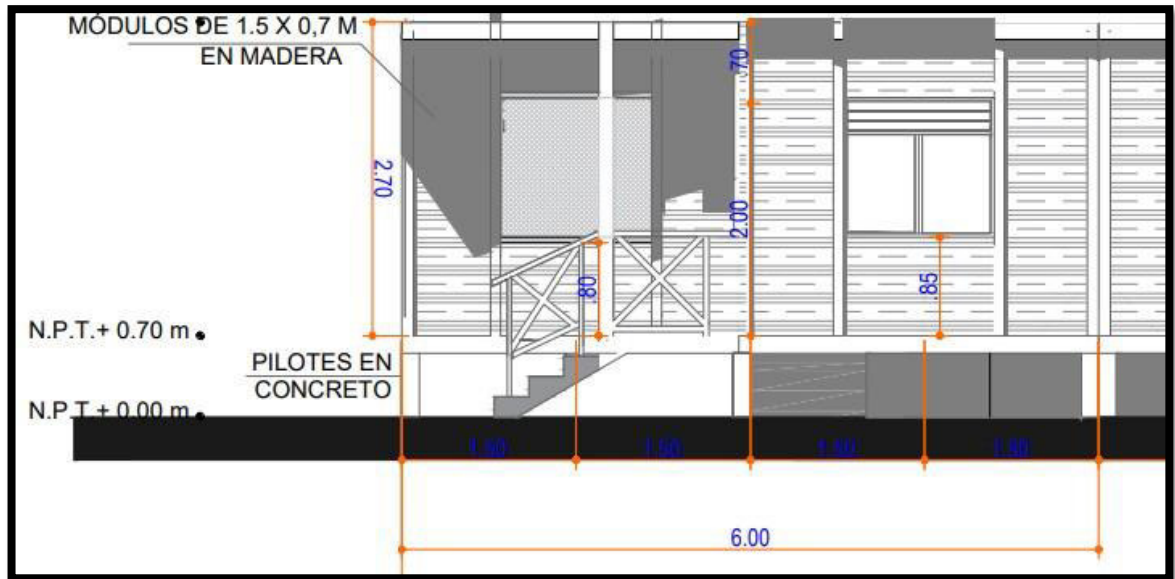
Alzado frontal detalle para una vivienda. Fuente: Elaboración propia.
